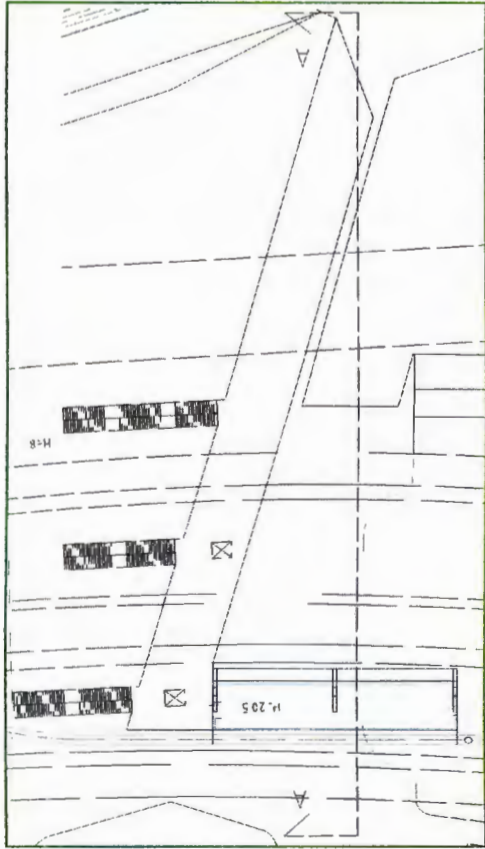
Plan av stasjonen for Monorail-systemet
